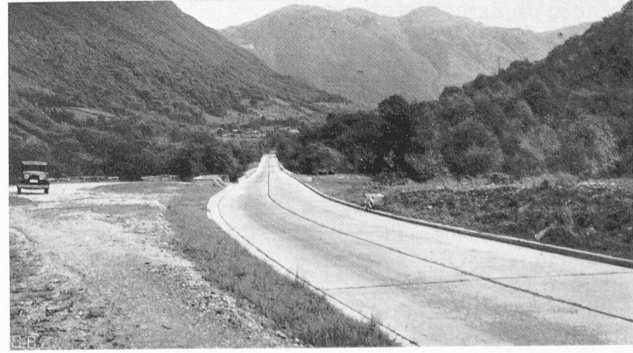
Betonstrasse mit Griffbelag Ceneri Südrampe, bis 9% Neigung.
